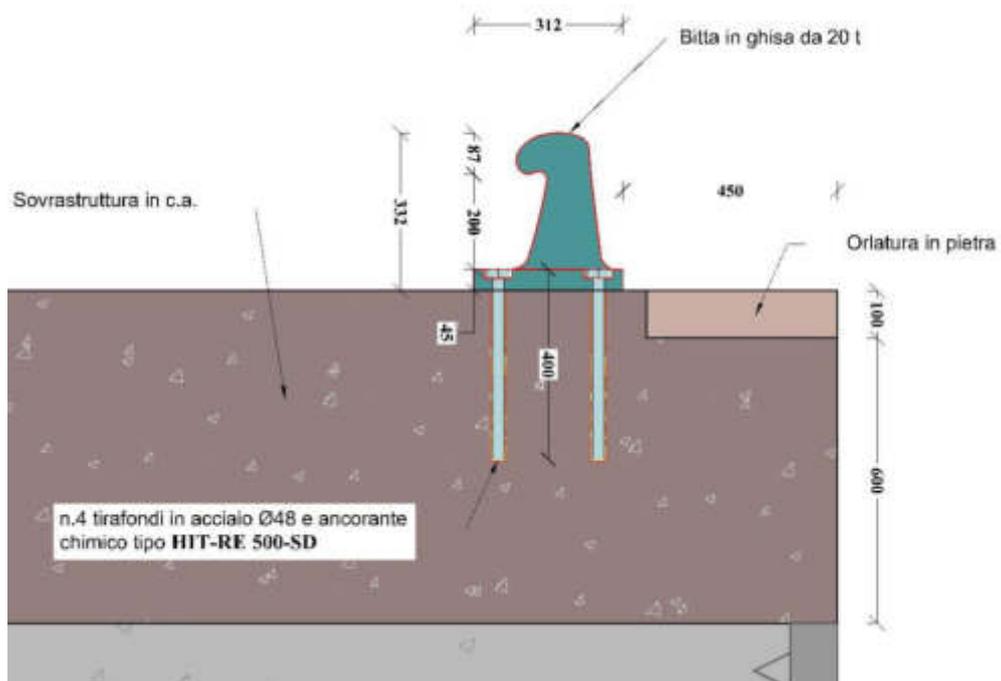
Sezione tipo della bitta da 20 ton posta sulla banchina di riva centrale
